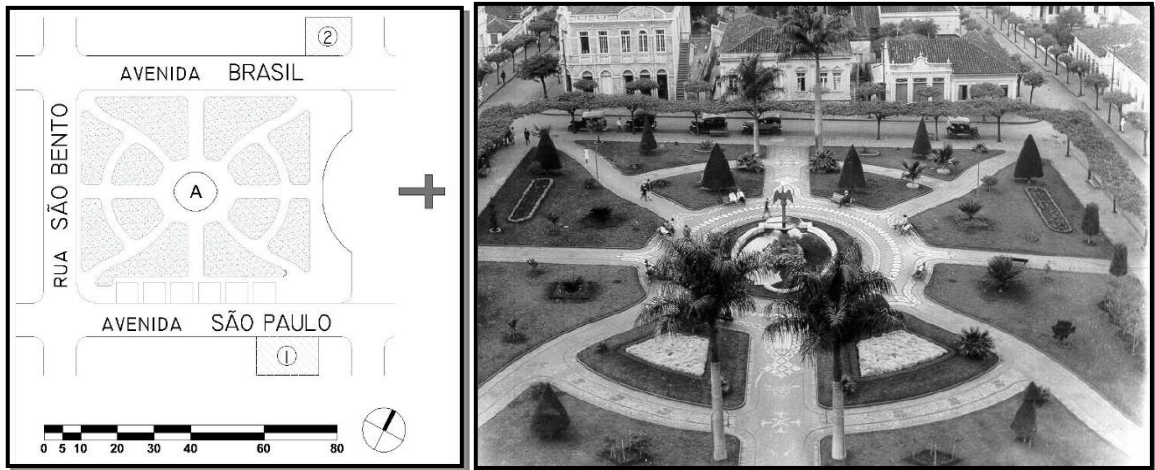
Planta original do primeiro traçado da Praça da Matriz.
